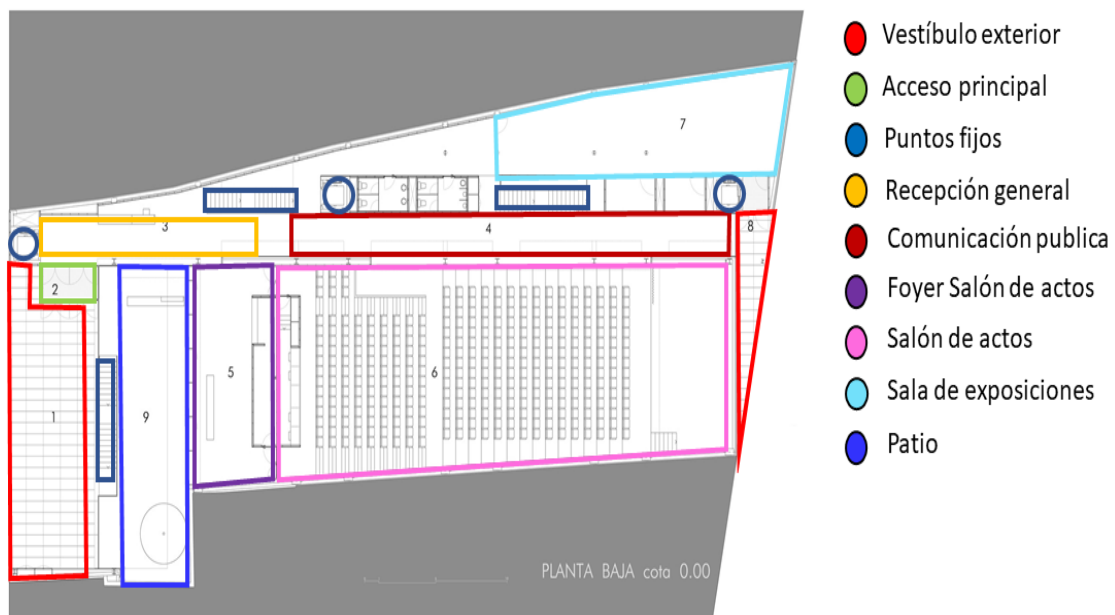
Centro Cívico Municipal de Boecillo-Planta Baja
